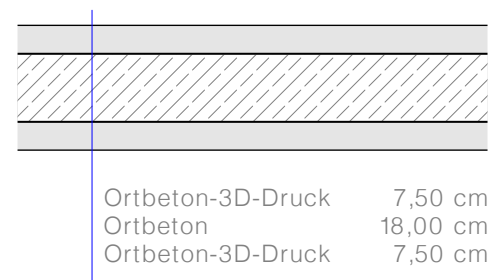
Bürogebäude Wandaufbau Innenwand | M 1.20
